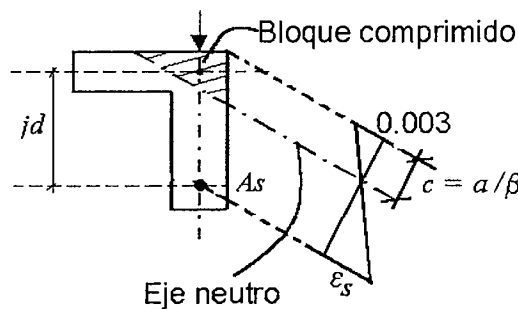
Inclinación del eje neutro en una sección asimétrica con plano de cargas vertical.
